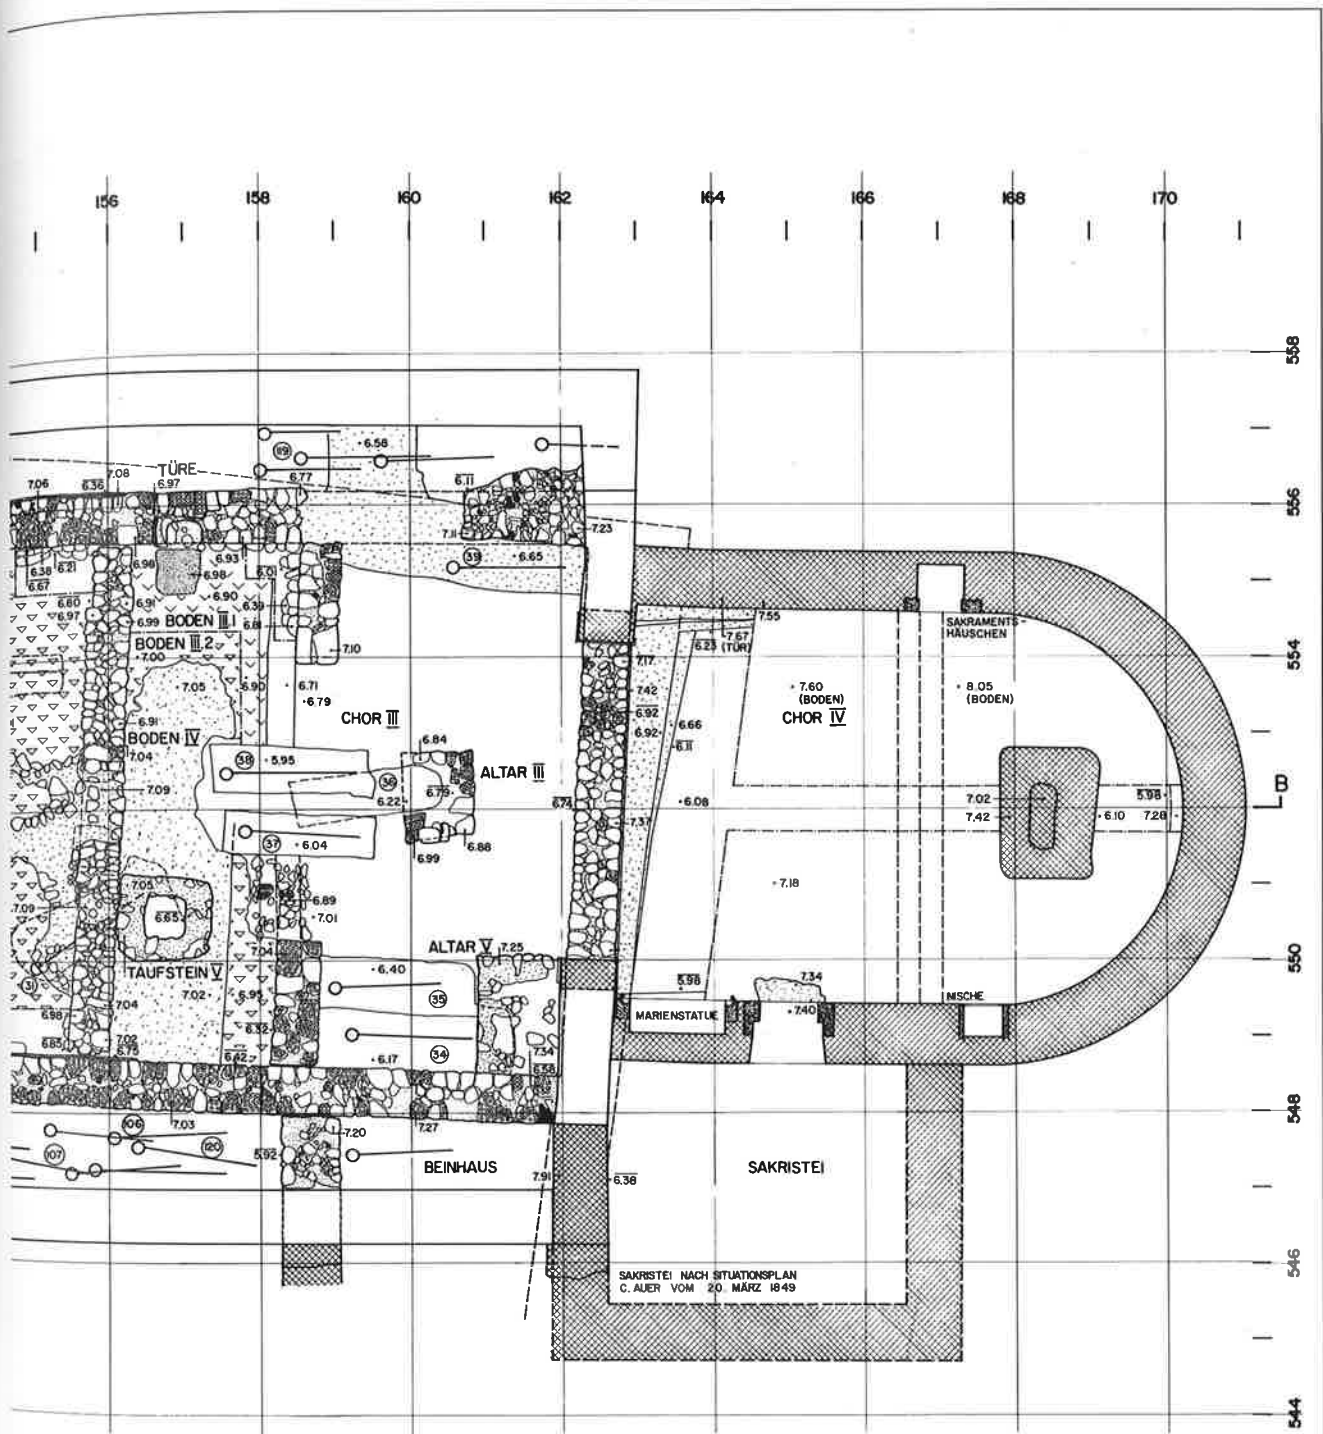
Stein am Rhein. Kirche Burg. Grundriss der Bauphasen III-V. M 1:100.
